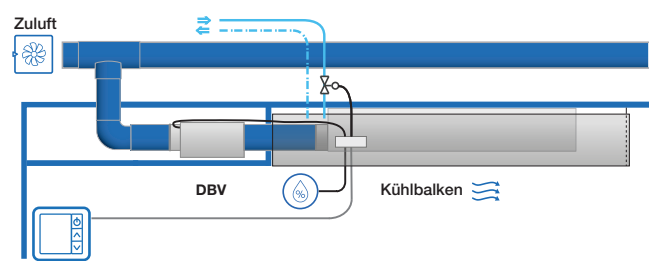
Plafond XD mit DBV-Anschlusskasten.
